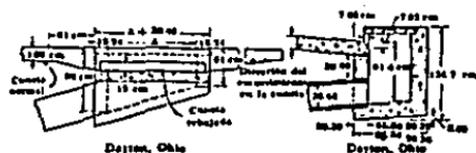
Boca o caladras de calle, en Dayton, Ohio. (Seyda Public Works, Mayo 1954, Pág. 108)
